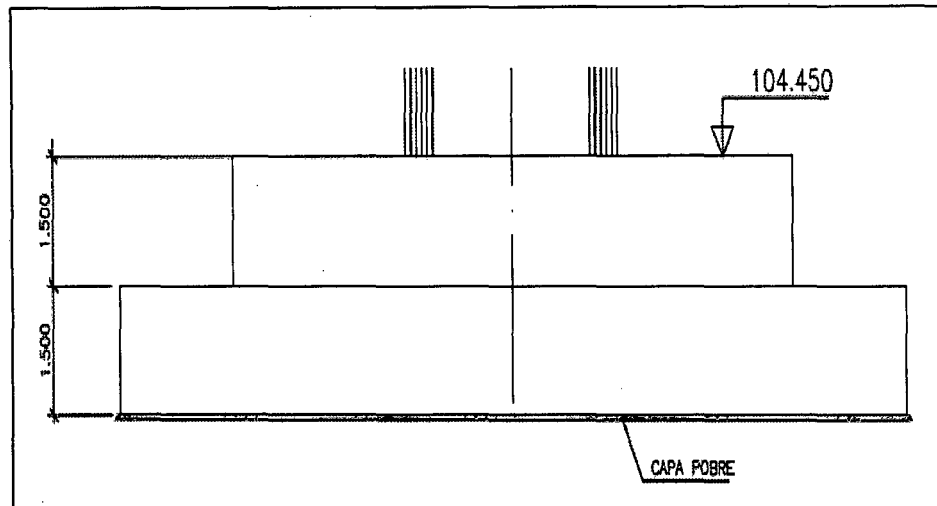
Sección transversal de zapata del tramo curvo
